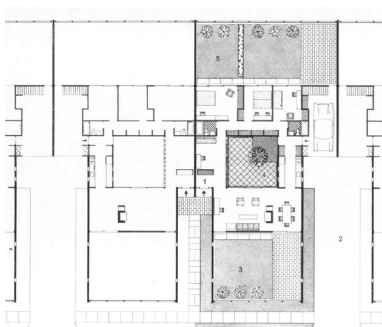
Projeto da casa de Sert construída em Camdrige, Massachusetts (1958).
